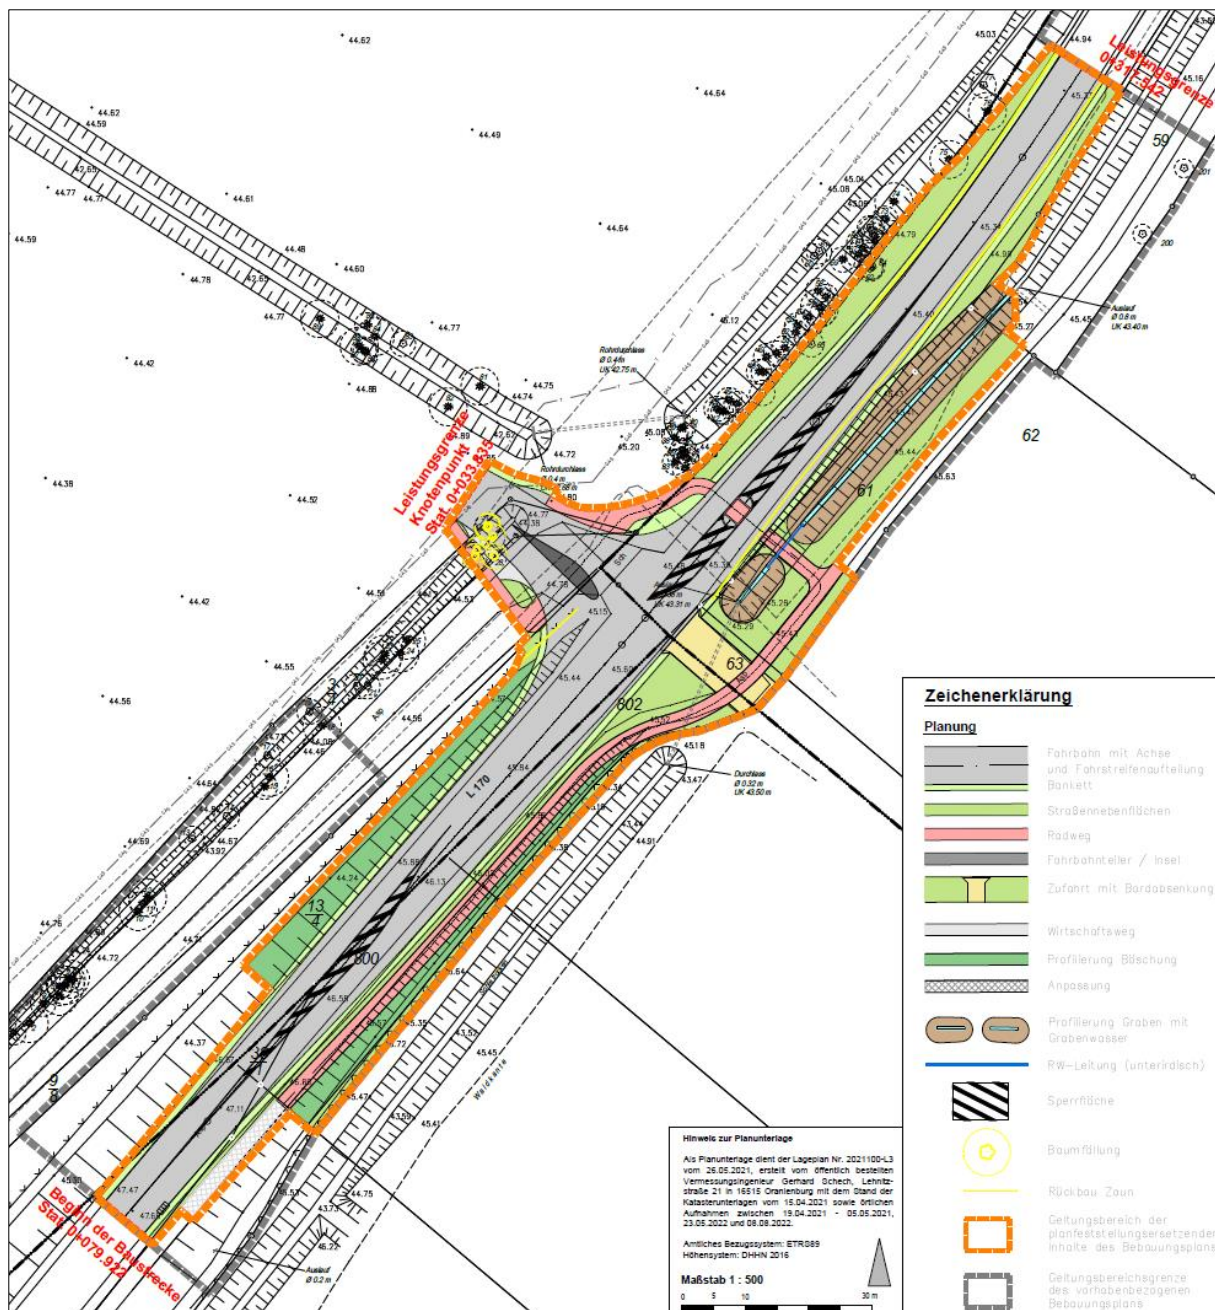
Ausschnitt Planzeichnung Teil B – planfeststellungsersetzende Inhalte des Bebauungsplans
